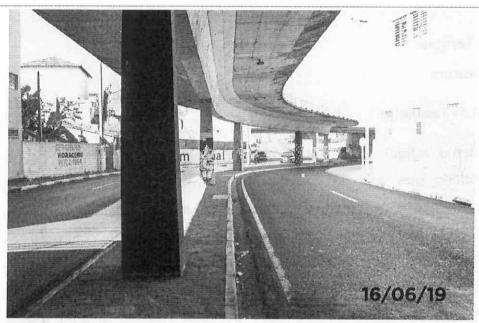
Detalhe de pilares sem proteção, barreira rígida ou metálica.
